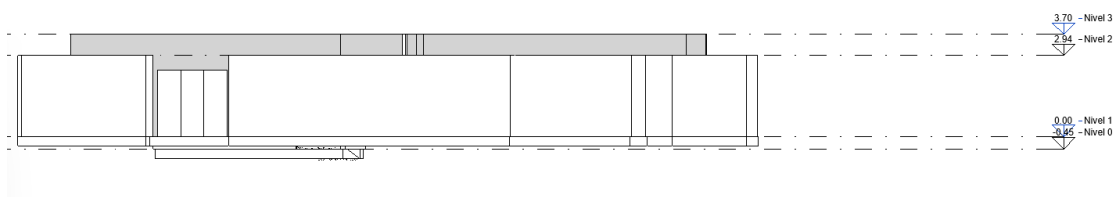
Alzado Oeste modelo levantamiento con SLAM. Fuente: elaboración propia.
